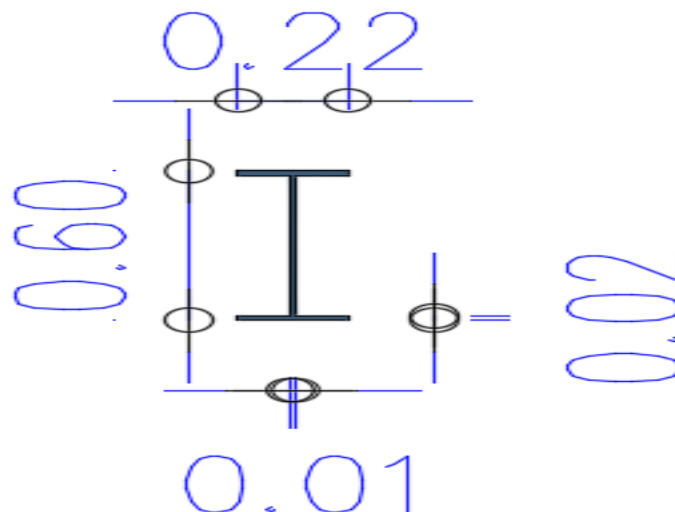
Les Dimensions de la Section Transversale Entretoise
